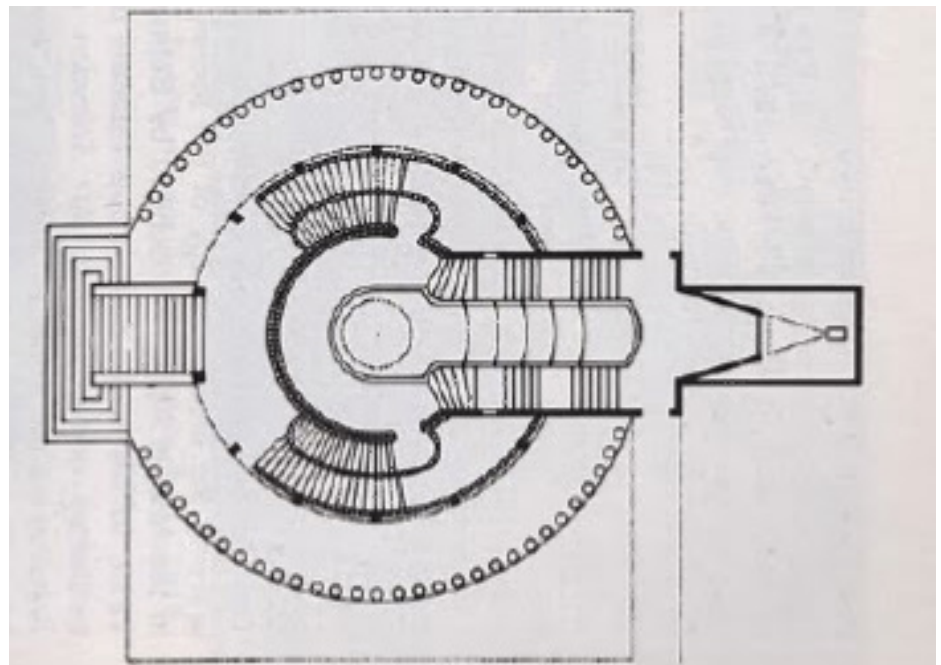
Planta Pabellón del Cristal en la Exposición Werkbund, Colonia, 1914.
